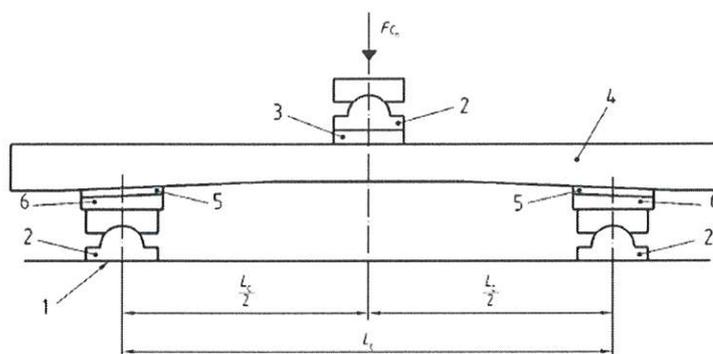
Montage d'essai de la section sous rail pour l'essai positif
